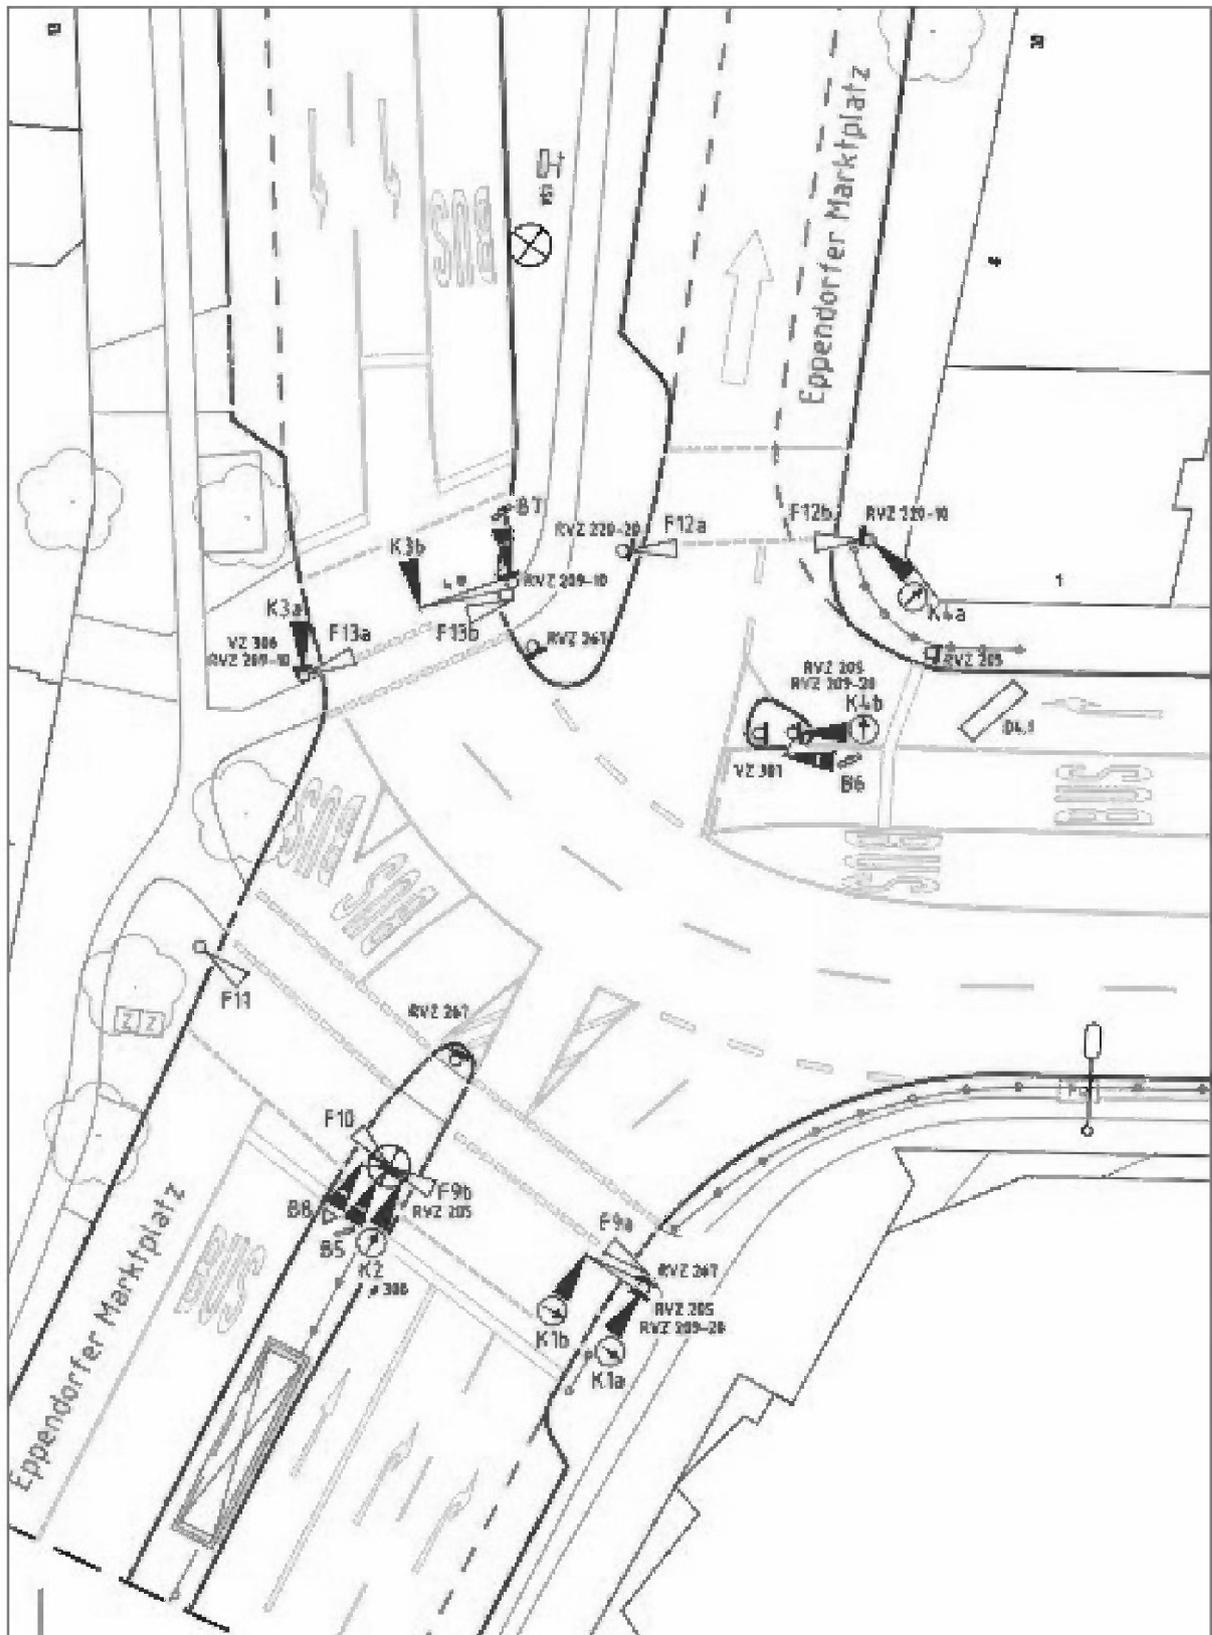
2 Signallageplanausschnitt LSA 1882
